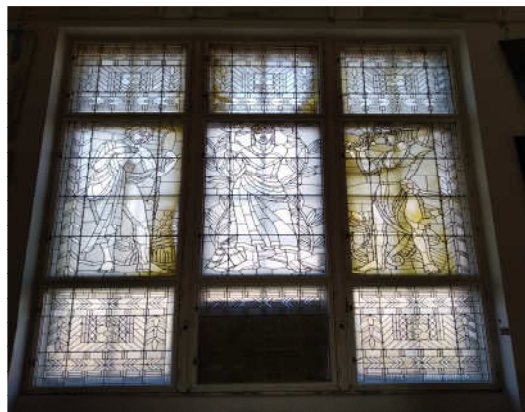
FOTO STÁVAJÍCÍ STAV - EXTERIÉR
